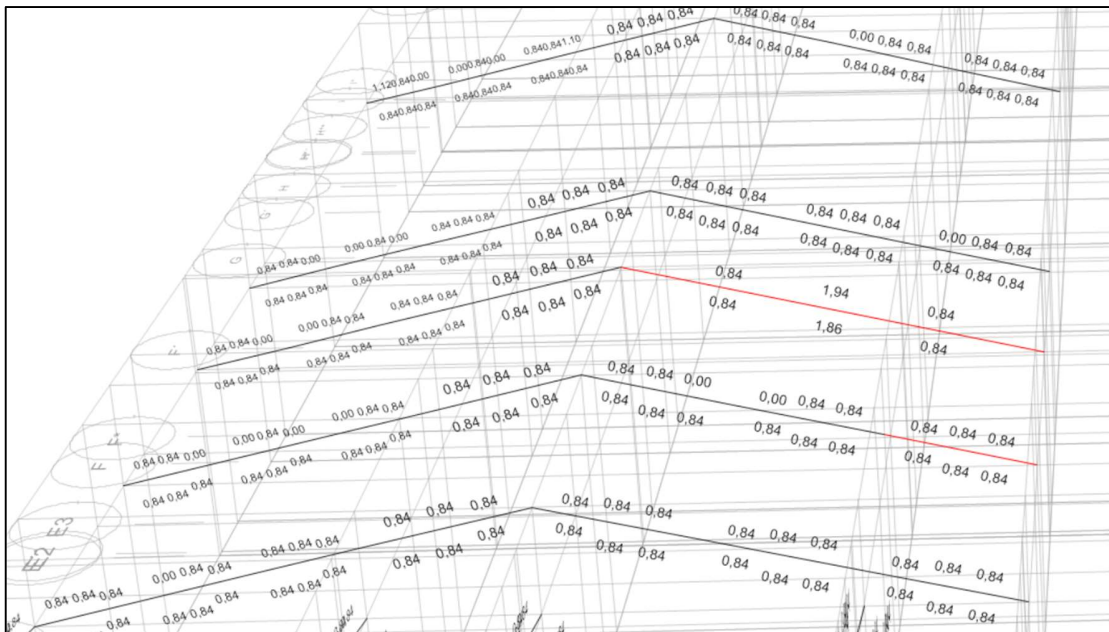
Acero de diseño de vigas Cubierta (V1\_12CMX25CM). Sector entre ejes D-I y I-5.
